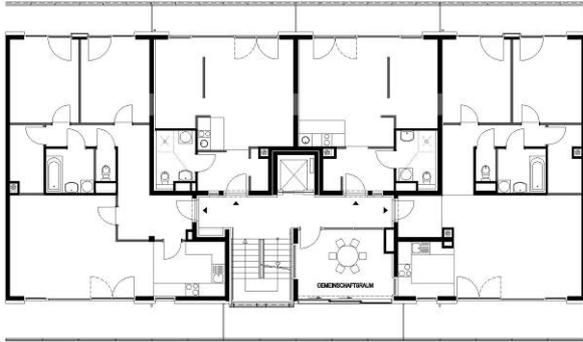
Frauen-Werk-Stadt II, Grundrissbeispiel; maßstabslos. Quelle: Arch Zwingl
